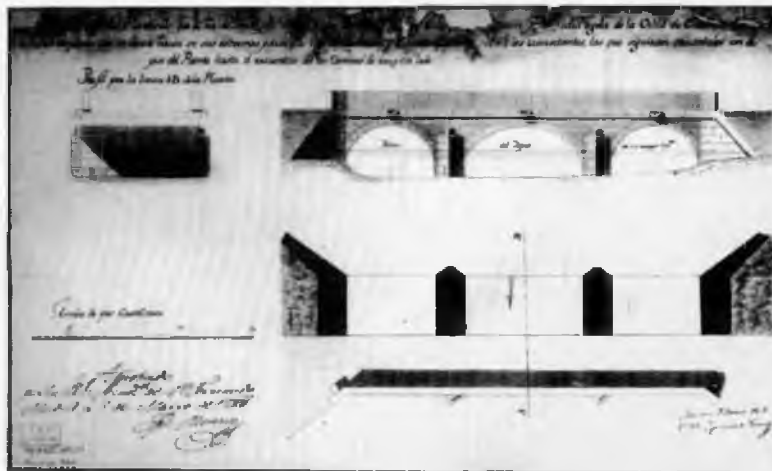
Puente de Escalona, sobre el río Alberche. AHN, plano número 249.
